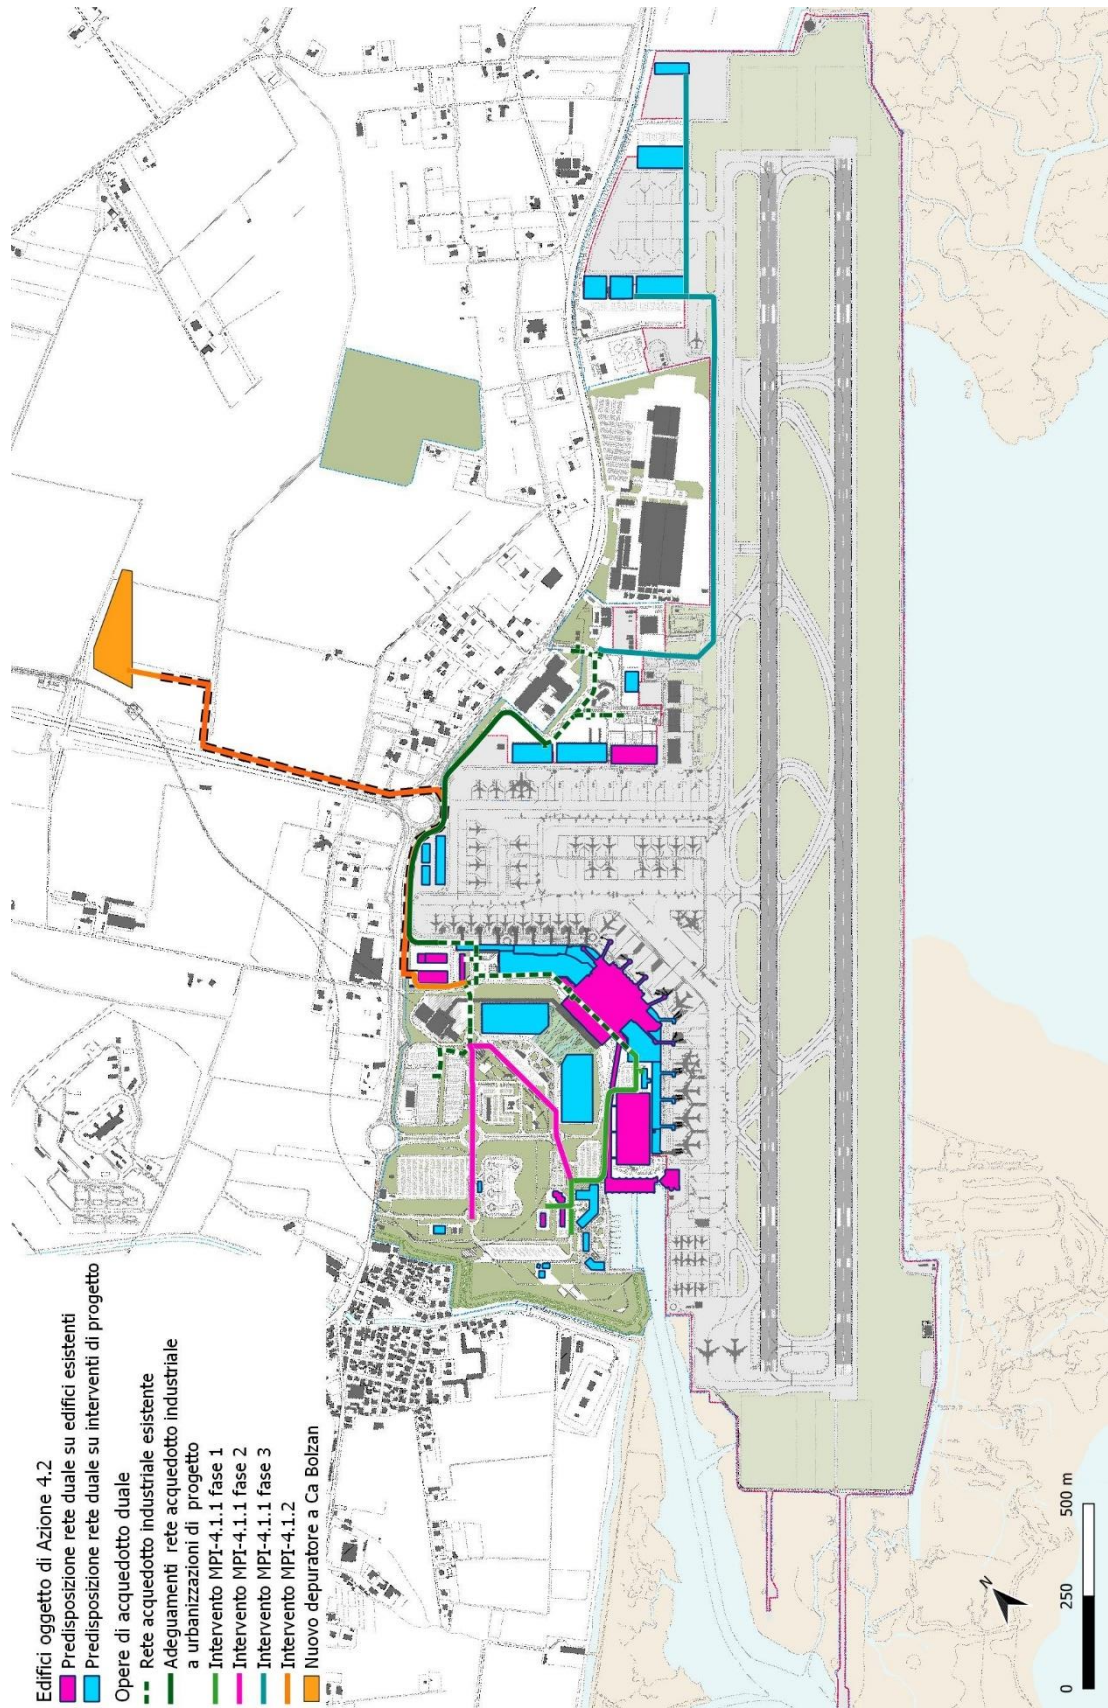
Azione 4.2 – Disposizioni generali per l’implementazione della rete duale all’interno degli edifici.
